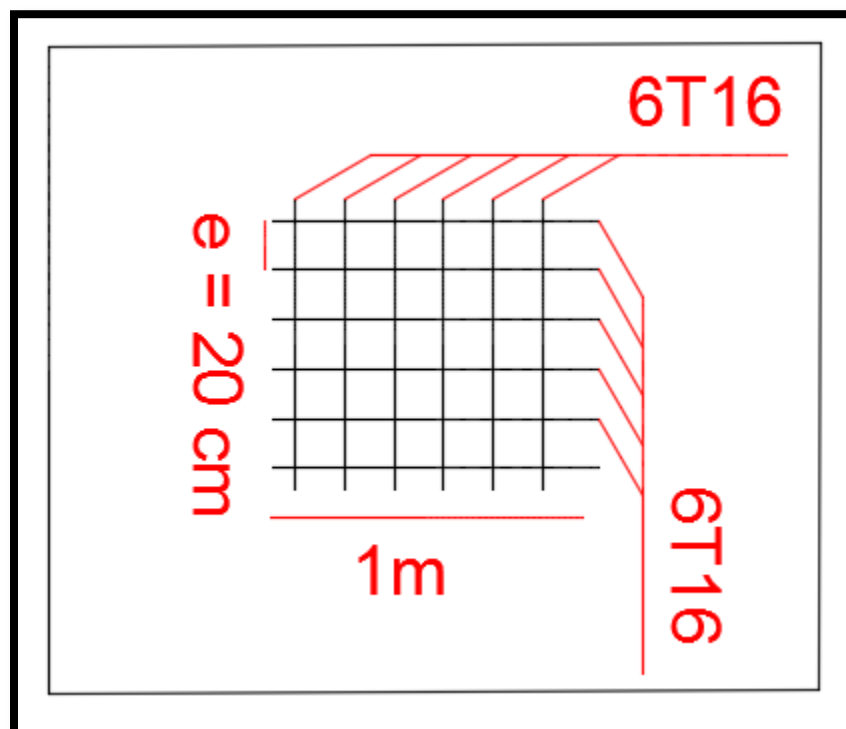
Le schéma du ferrailage de la dalle du radier.
